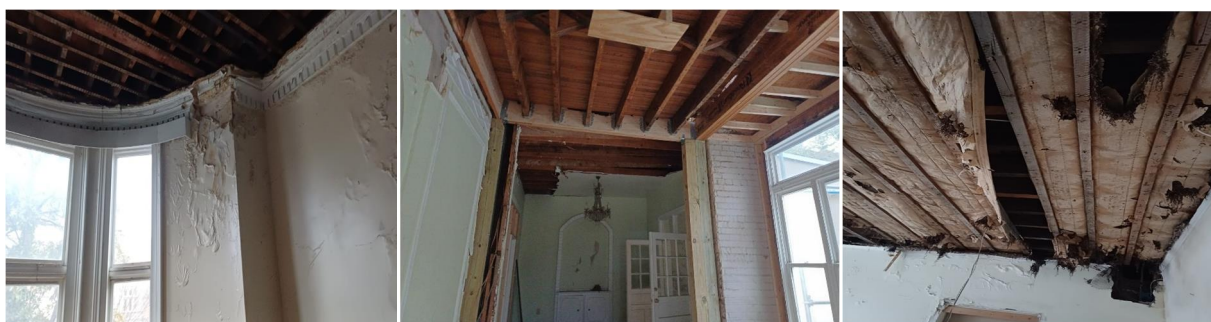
Toiture- Ambassade de Madagascar à Washington
